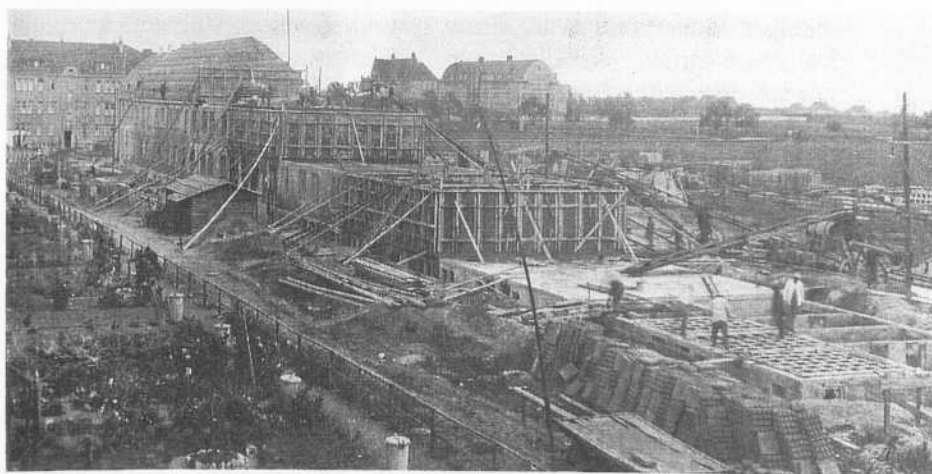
Baustellenfoto mit Taktstraße in der Gerostraße, Merseburg (1930)
